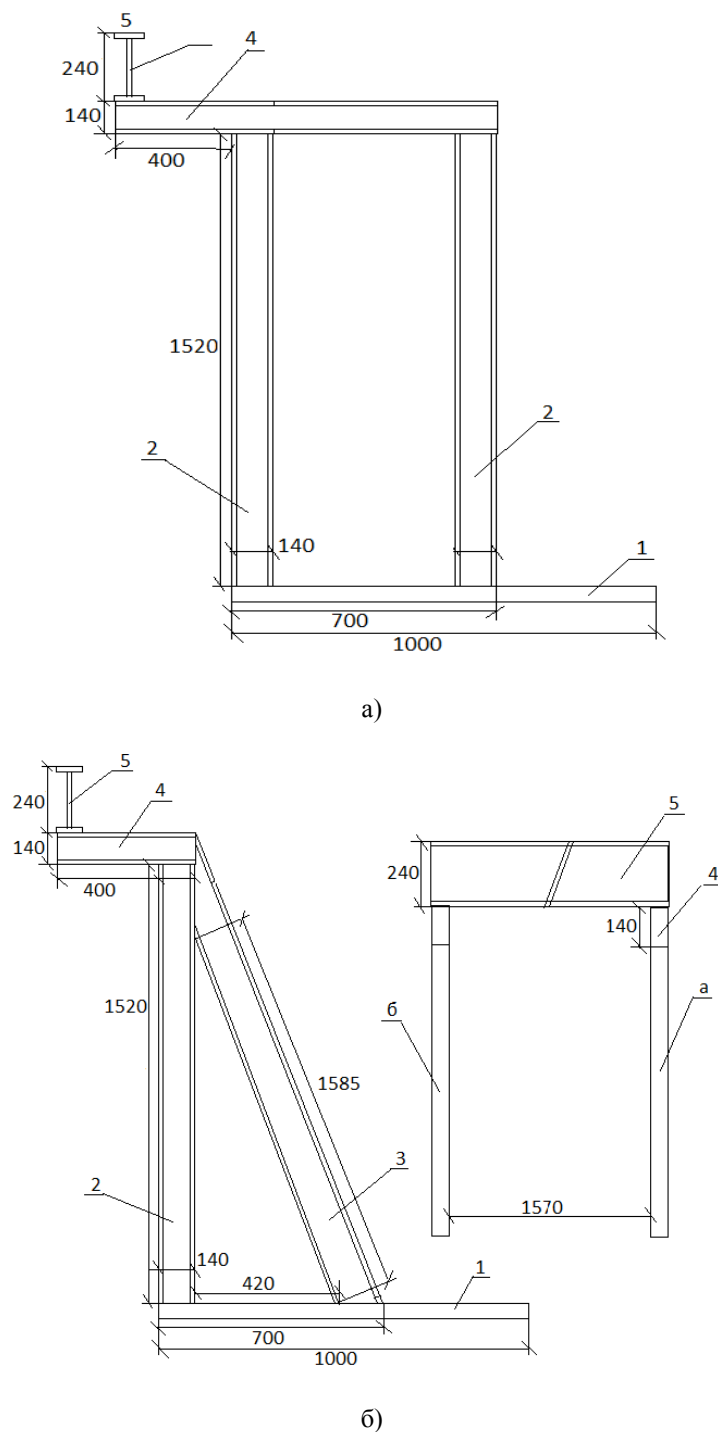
Обмерный чертеж узла крепления тали г/п 2 т. зав. № xxxx
